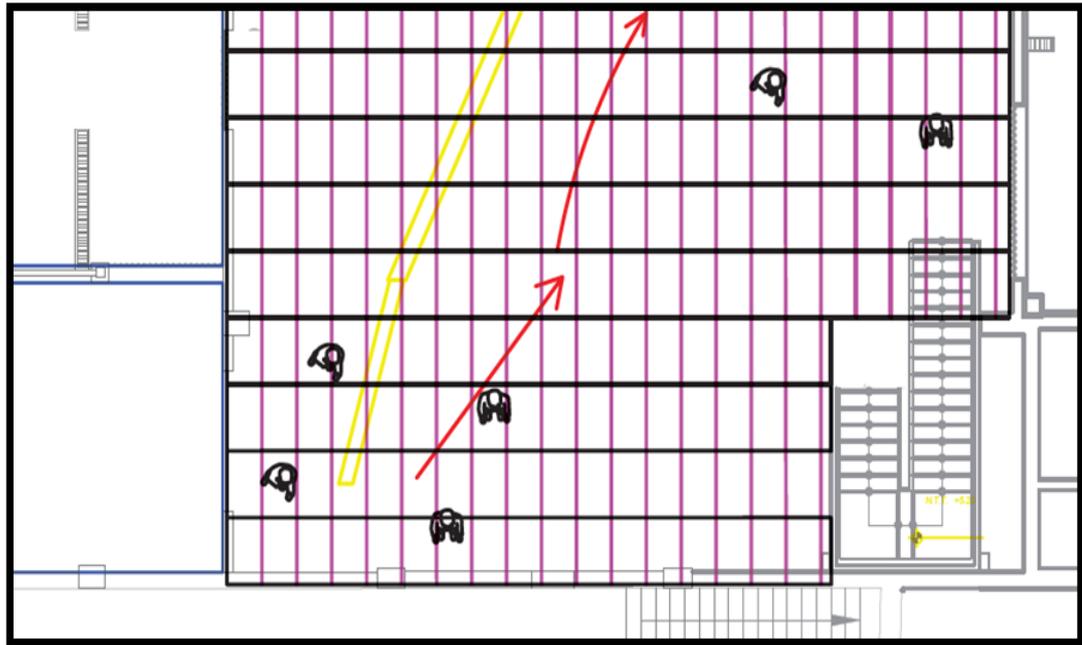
Layout de Vertido de concreto con mixer y bomba
